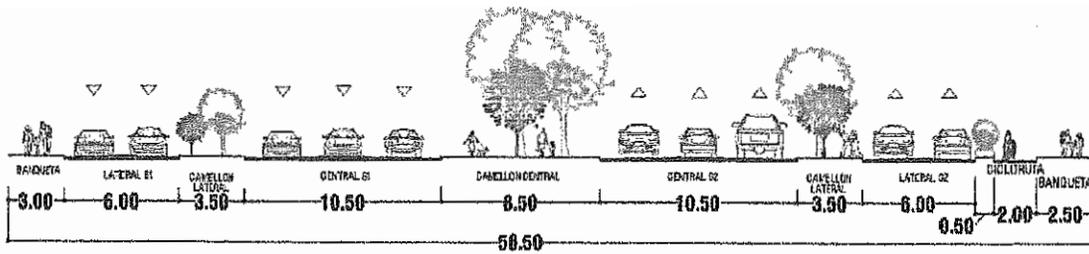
Estructura Vial y Conectividad. Fuente: Elaboración propia.
